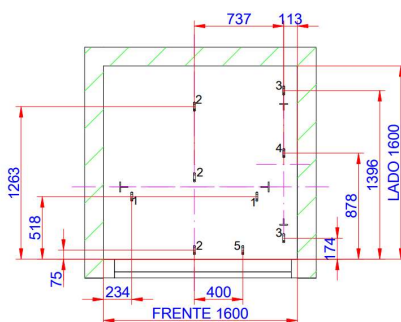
Detalhe do Gancho da Planta de Montagem.
